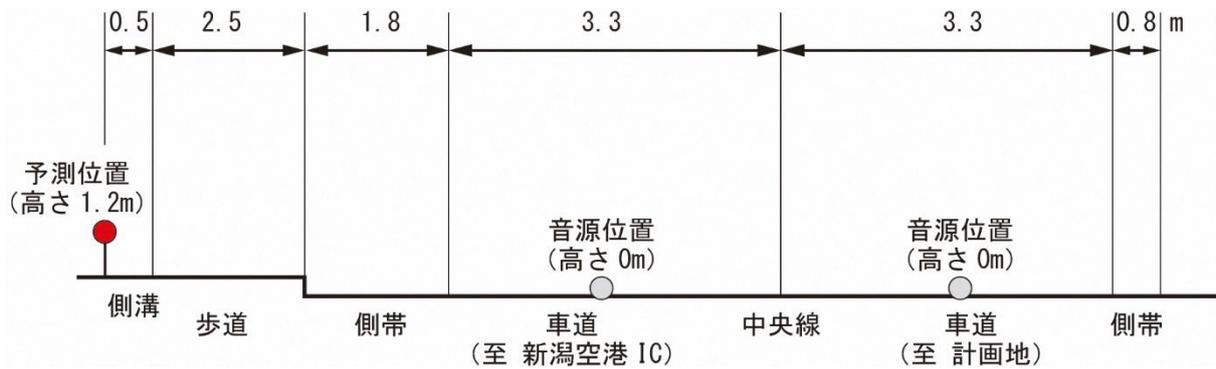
(3) 道路断面図 (No. 3 : 嘉瀬蔵岡線沿道 (東側))
